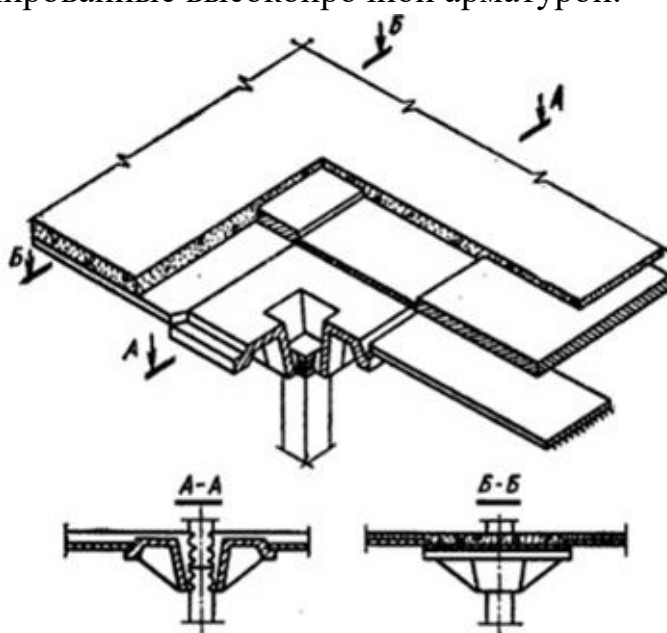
Конструкция безбалочного сборно-монолитного перекрытия
